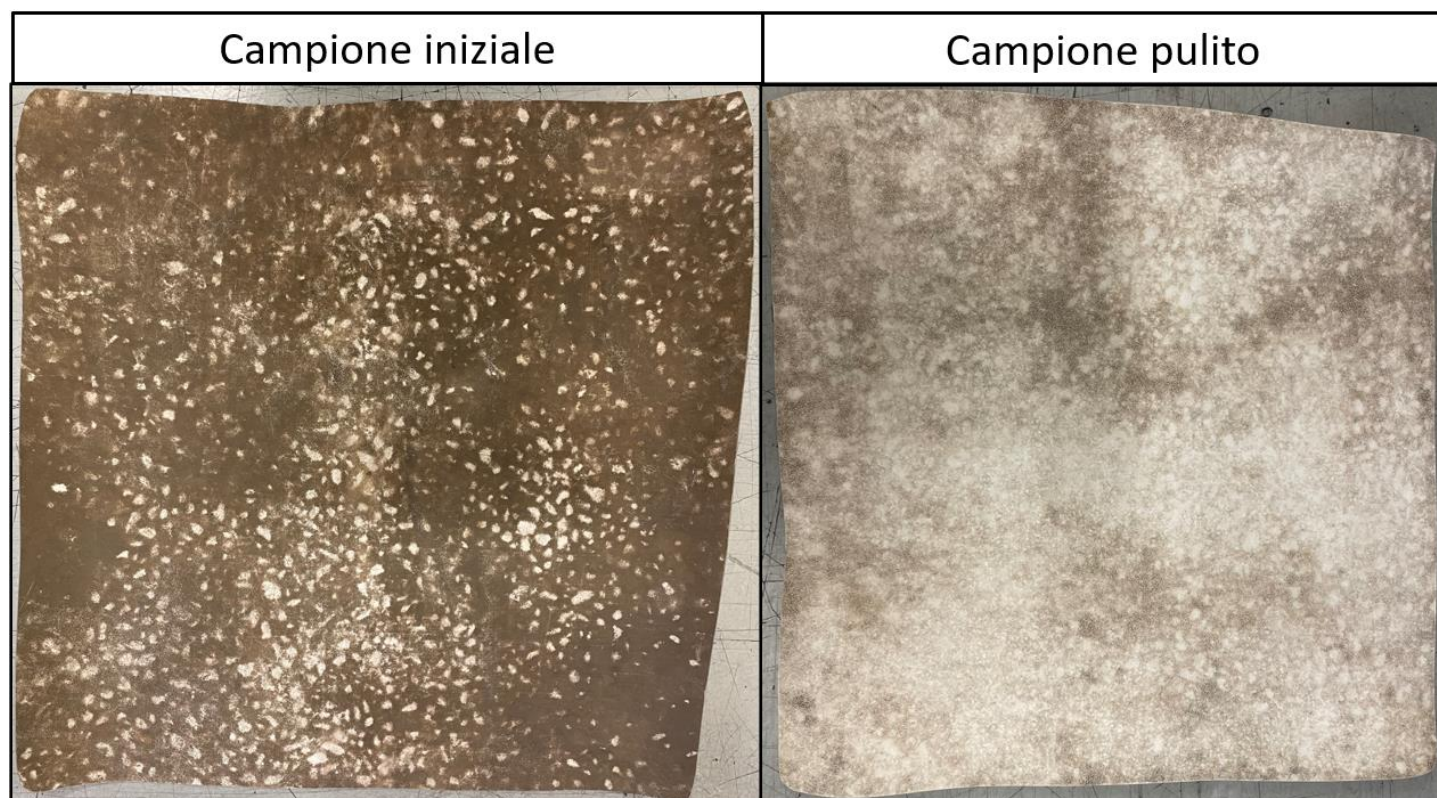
Immagine del campione prelevato dalla copertura sotto strato di zavorra in ghiaia
